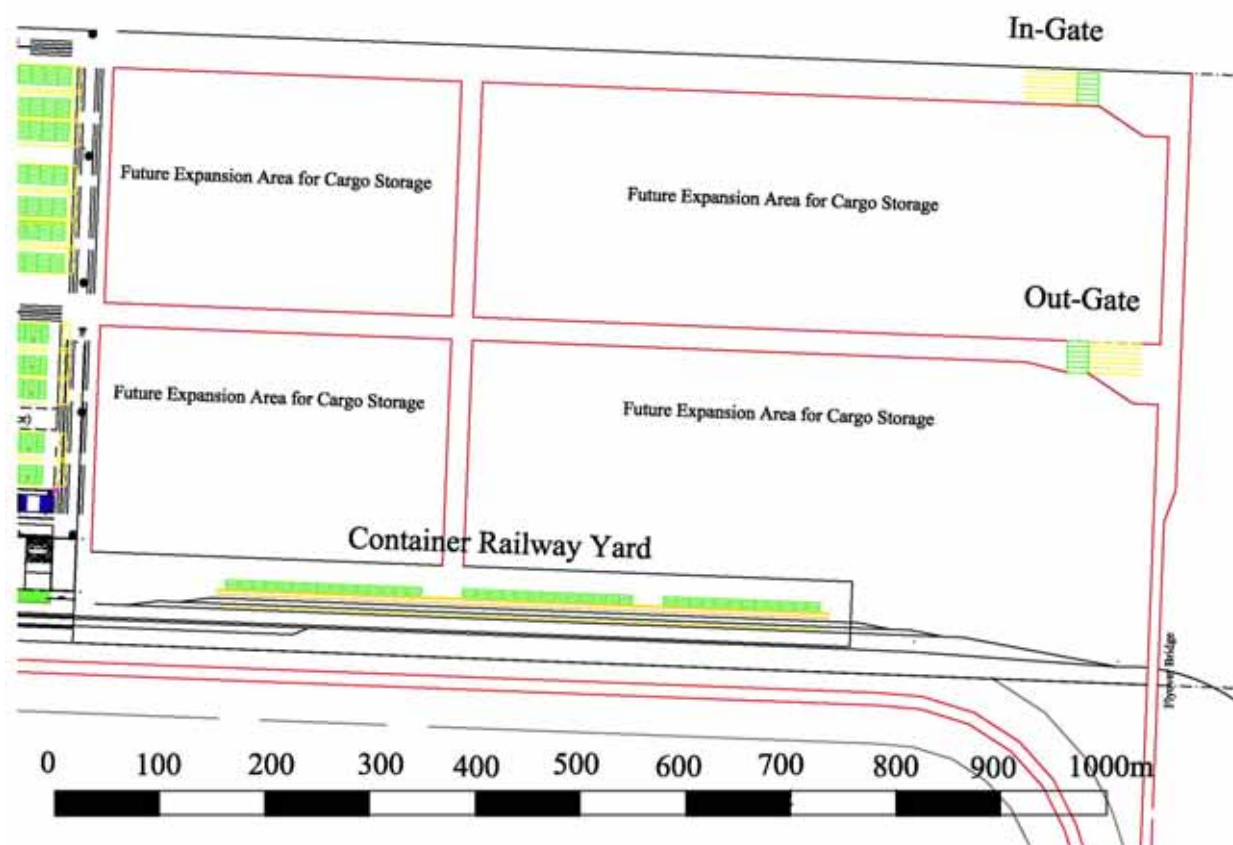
Layout do Plano das Instalações dum Novo Portão
